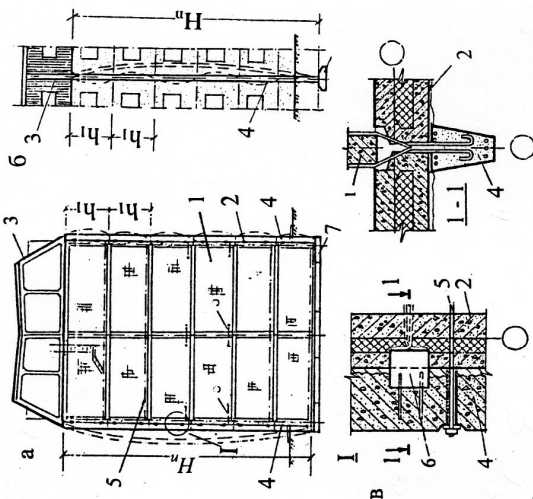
Реконструкция крупнопанельного пятиэтажного дома усовершенствованным методом «фламинго»
